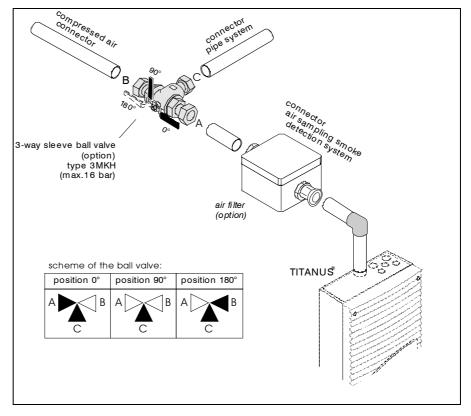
Montage des 3-Wege-Kugelhahns
